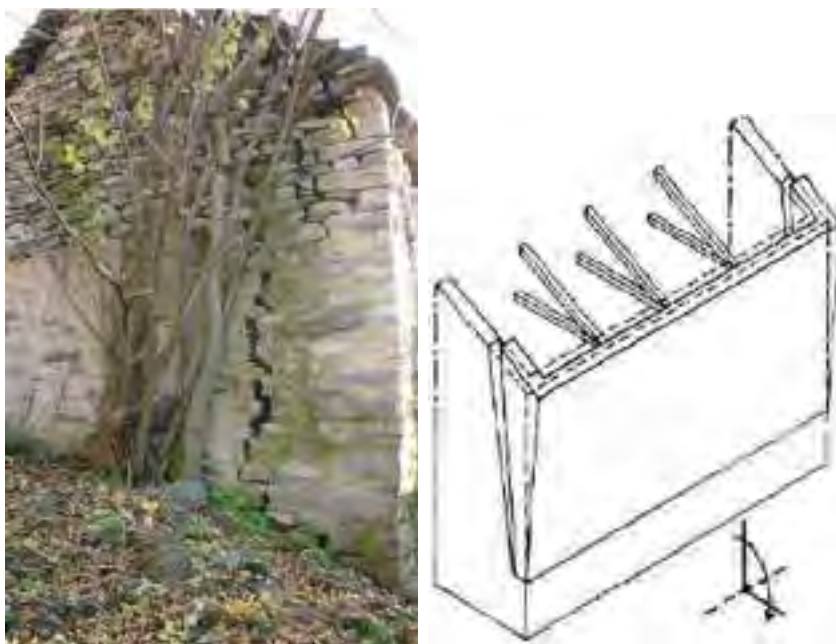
Foto e schema di ribaltamento fuori dal piano (Montecrestese).
